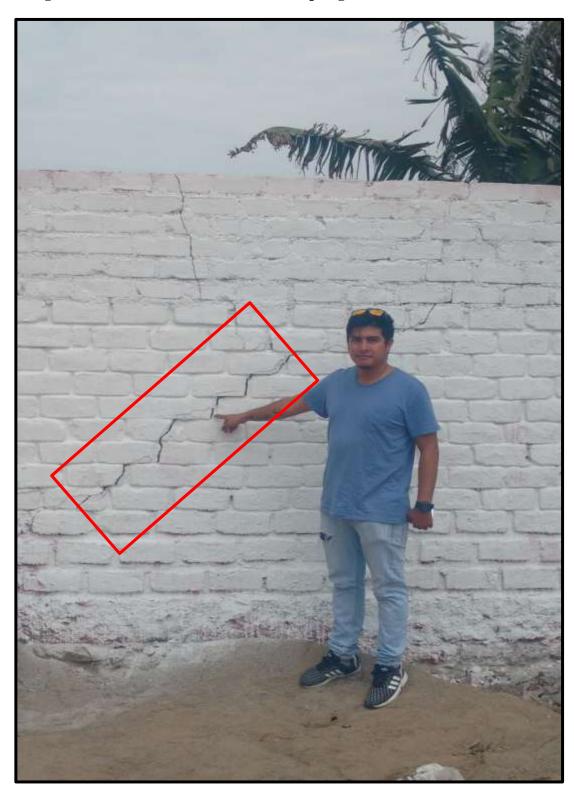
Muro de albañilería afectado por erosión en la Unidad Muestral 6.
